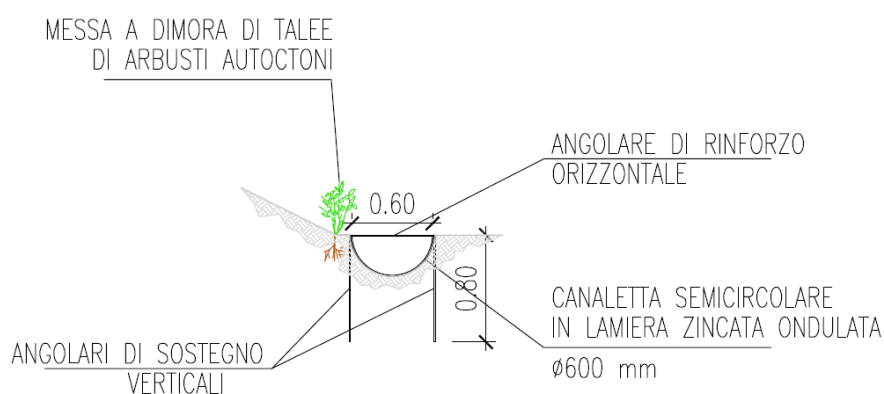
CANALETTA METALLICA A PROTEZIONE DELLE VIABILITÀ DI CANTIERE
